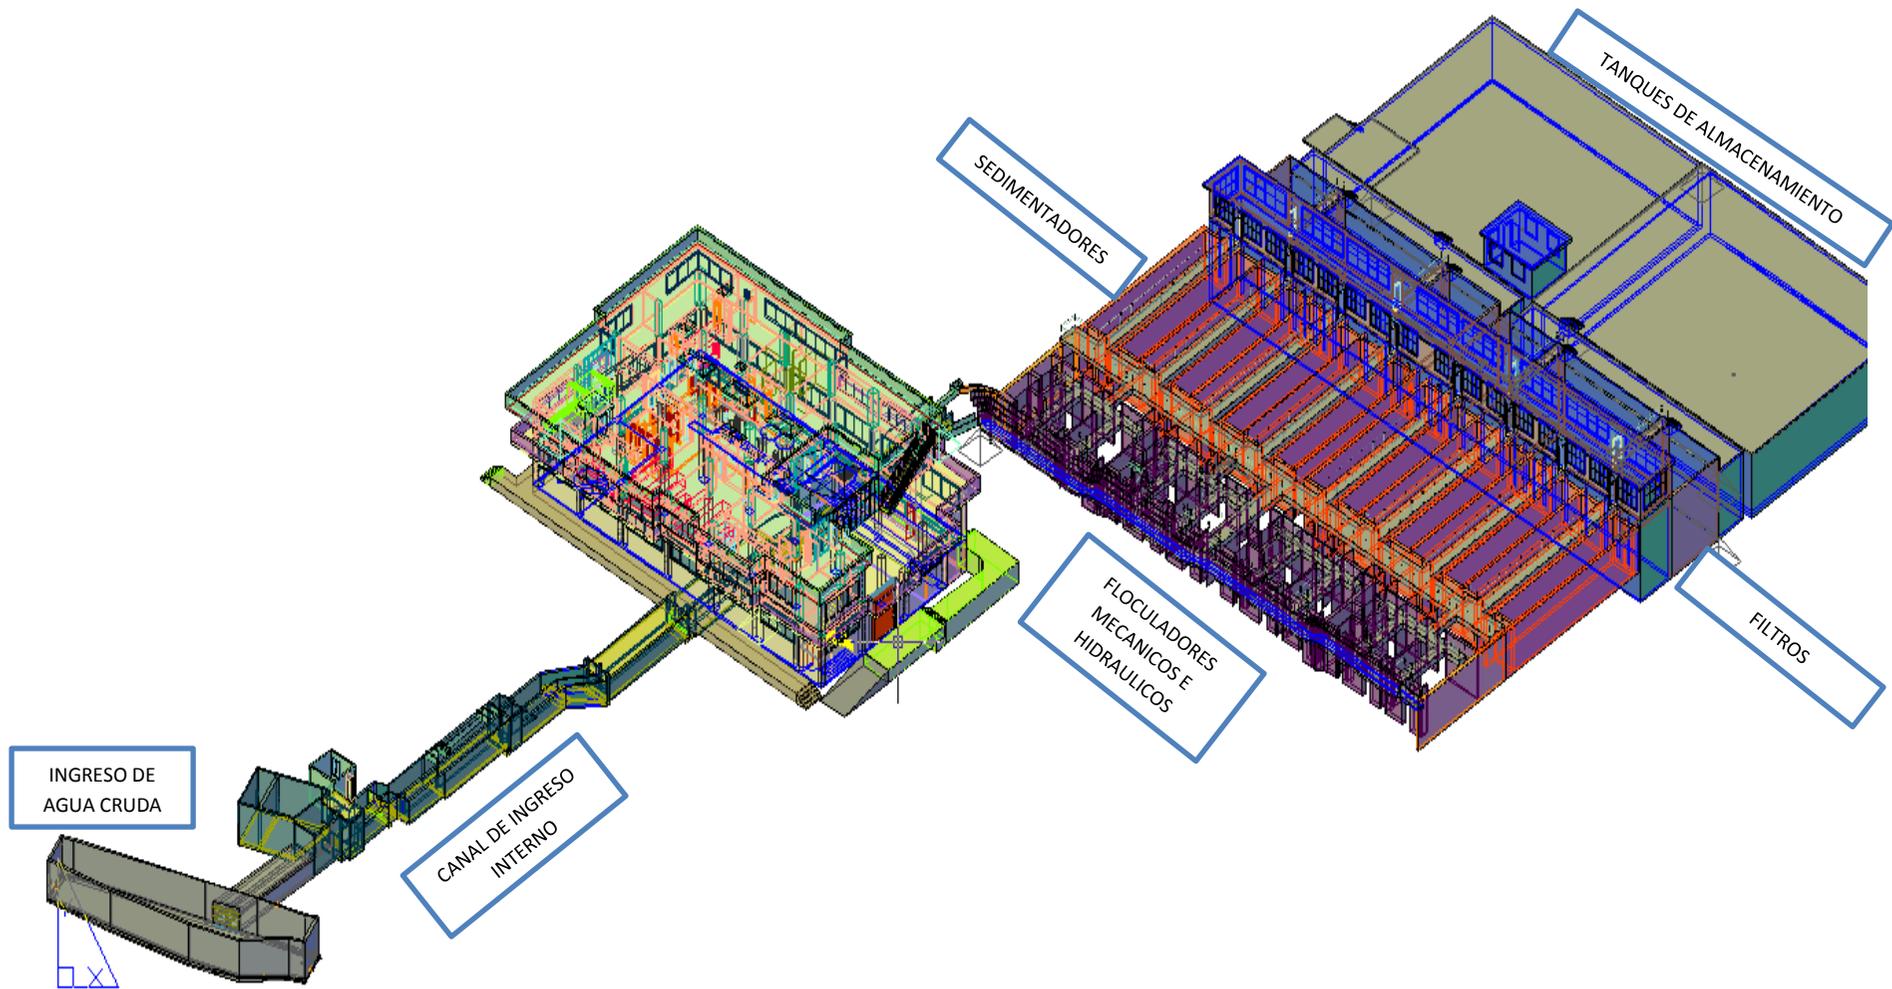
Lay Out de la Planta realizado por el Autor
